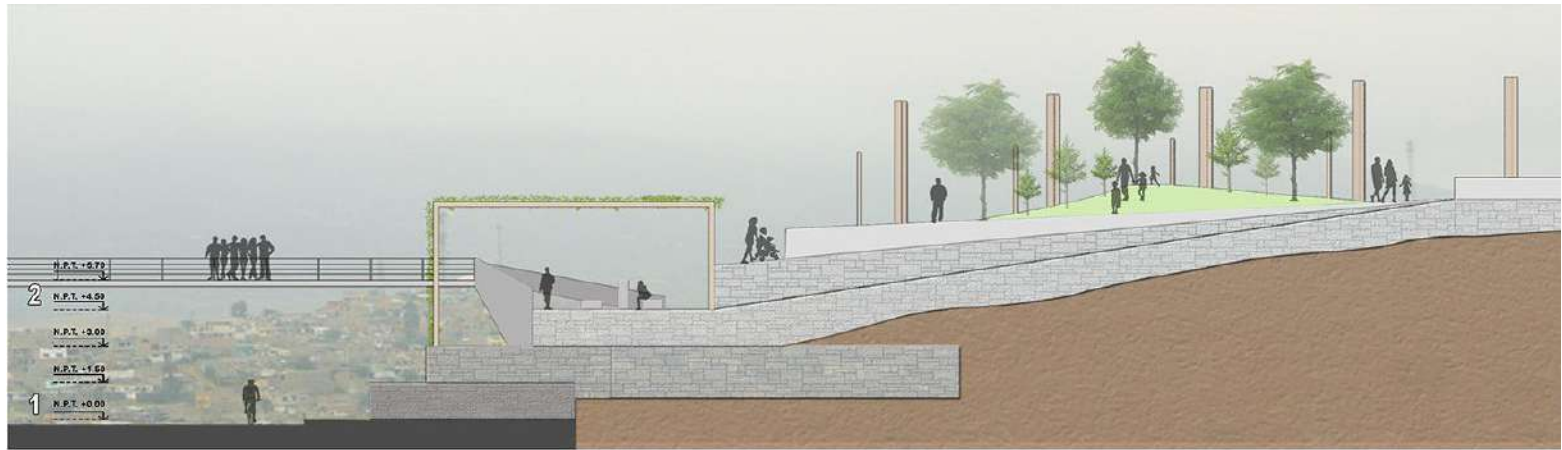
/Planta General (Proyecto Sr. de los Milagros)
